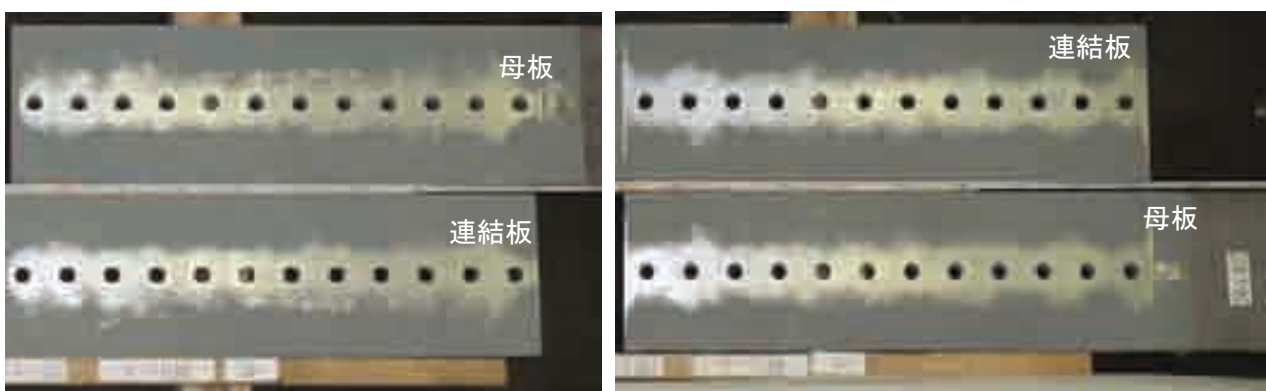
試験体 No.3-F すべり面の状況(左:ボルト側, 右:ナット側)
